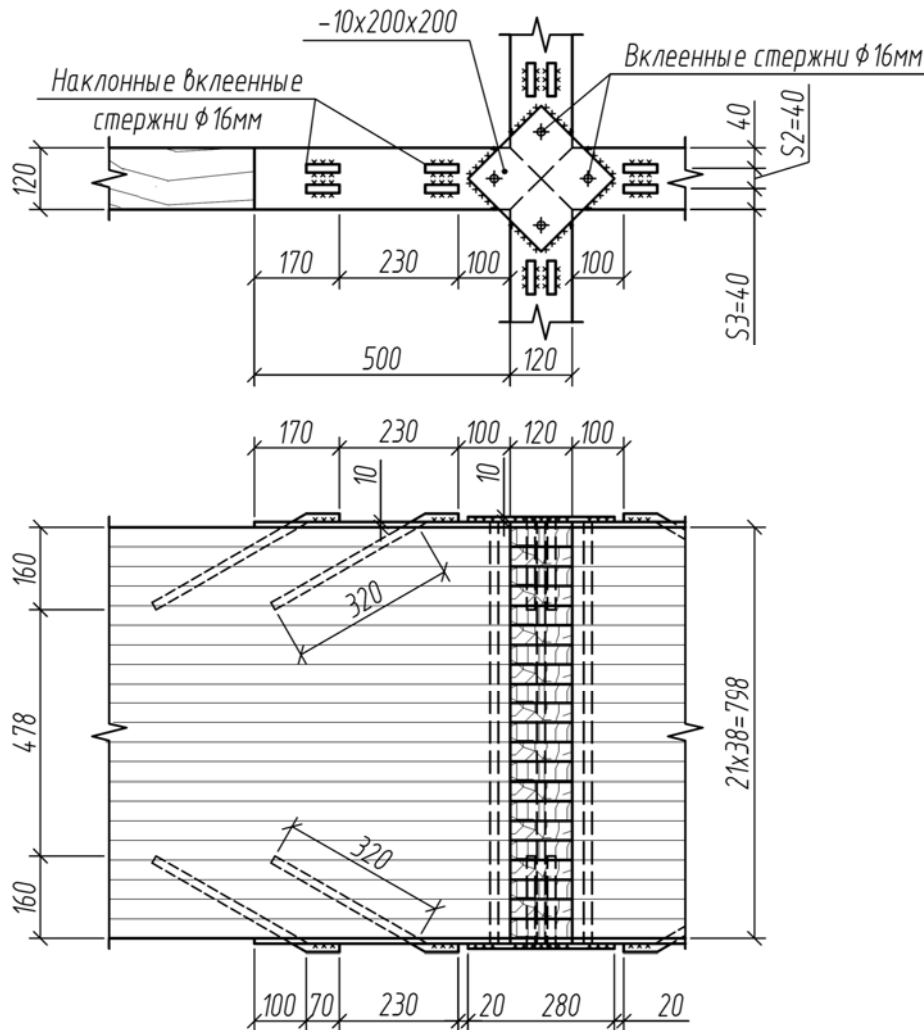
Конструкция узла сопряжения балок по варианту №4 (тип А)
